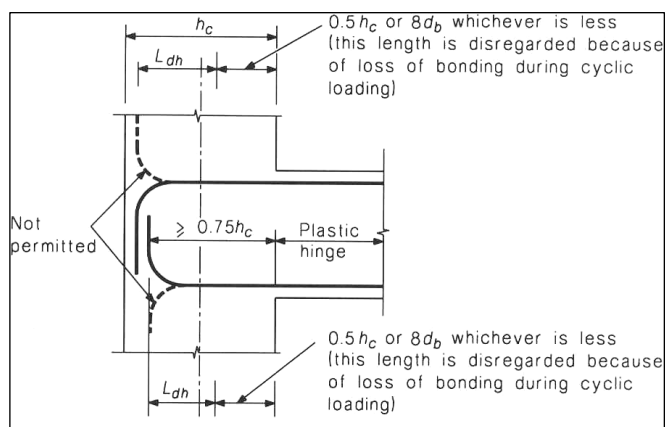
Anclaje de las barras de las vigas cuando la sección crítica de la rótula plástica se forma en la cara de las columnas. Fuente: C. Llopiz, 2001, p. 83.
